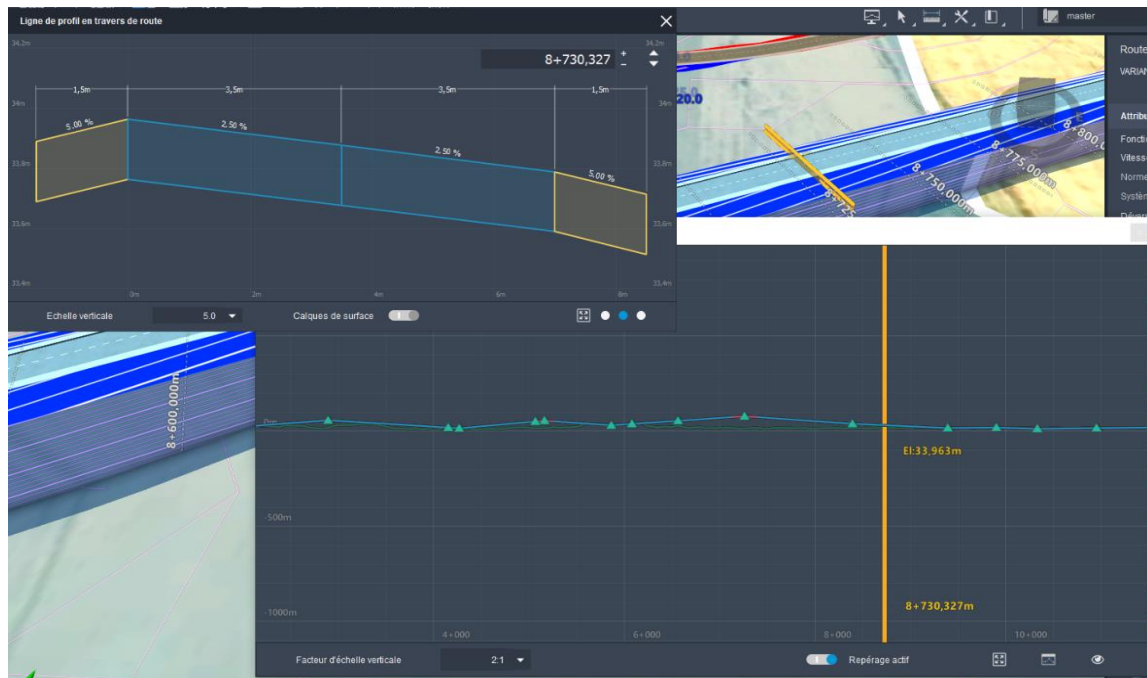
Interaction entre : profil en long, tracé en plan et profil en travers
